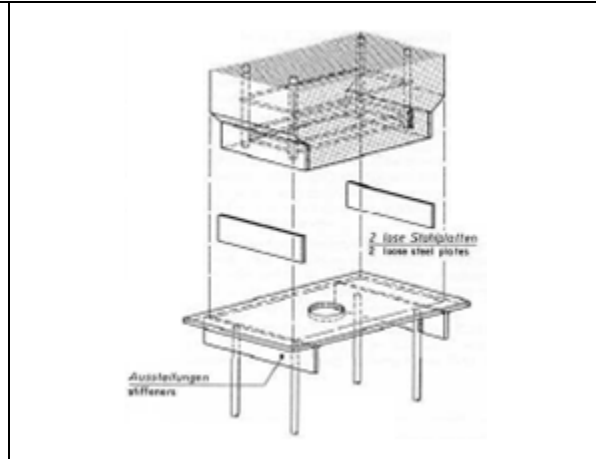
Ligação por soldadura a chapa (Stupré, 1981)
